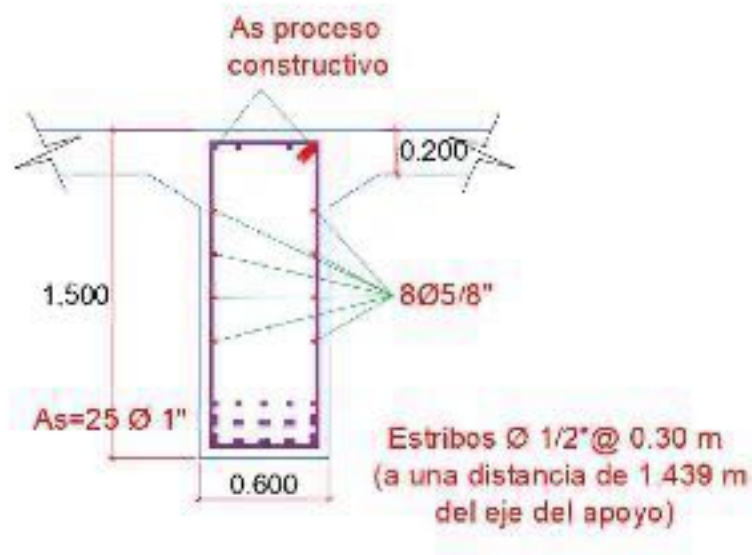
Armadura longitudinal y transversal en la viga exterior.
